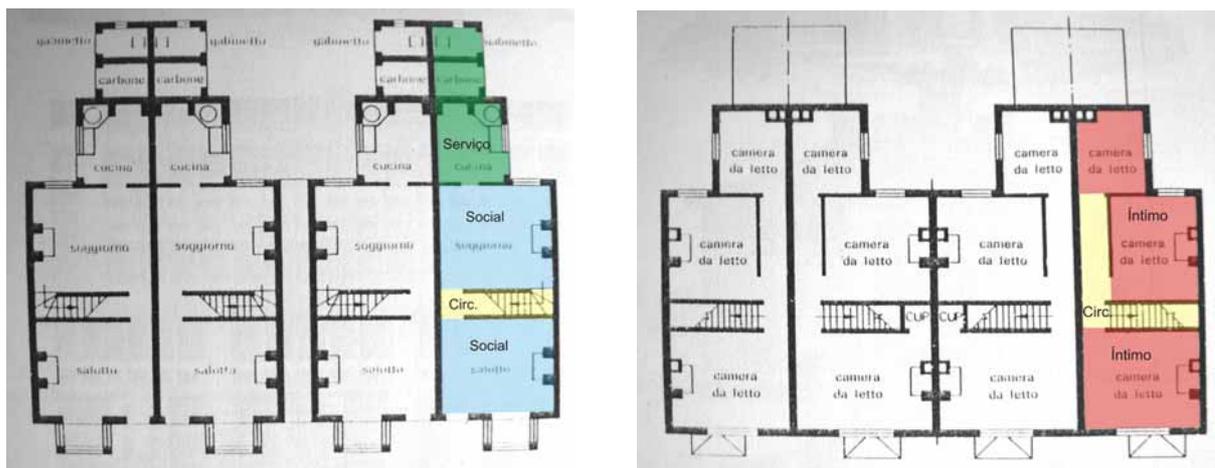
Planta baixa setorizada: segundo pavimento localizada no espaço do sótão Casa de segunda ordem da vila operária de Galópolis (Imagem editada pela autora)
